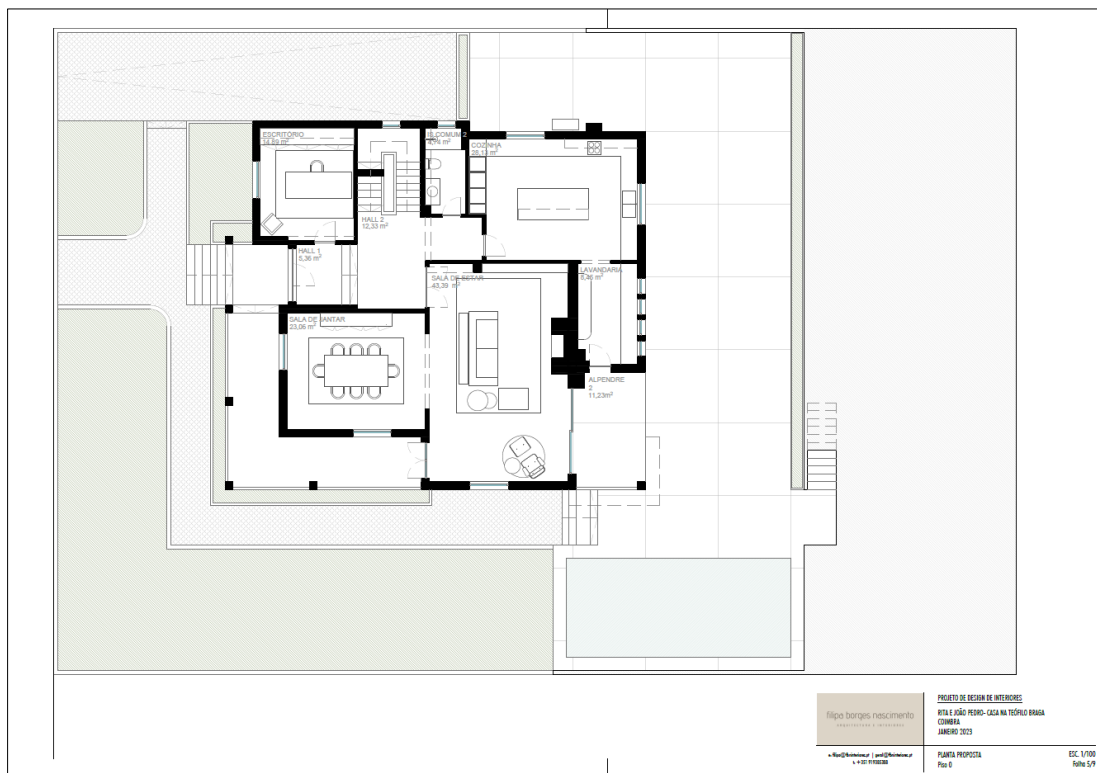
Planta proposta (Fonte: Autora, 2022)
